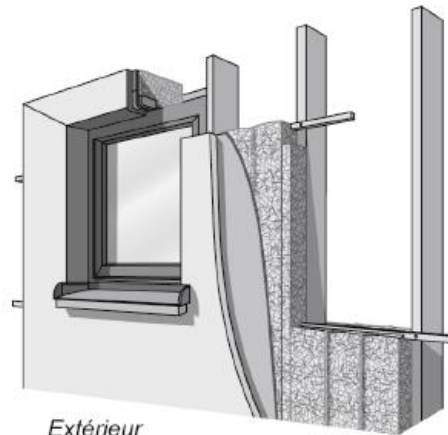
Exemple de remplissage « en tunnel » d'une double ossature secondaire avec structure noyée dans l'isolant : vue en plan
